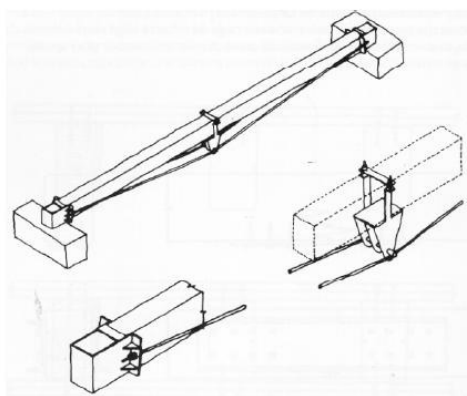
Aplicação de tirantes pré-esforçados para reforço estrutural (Arriaga, 2002).
